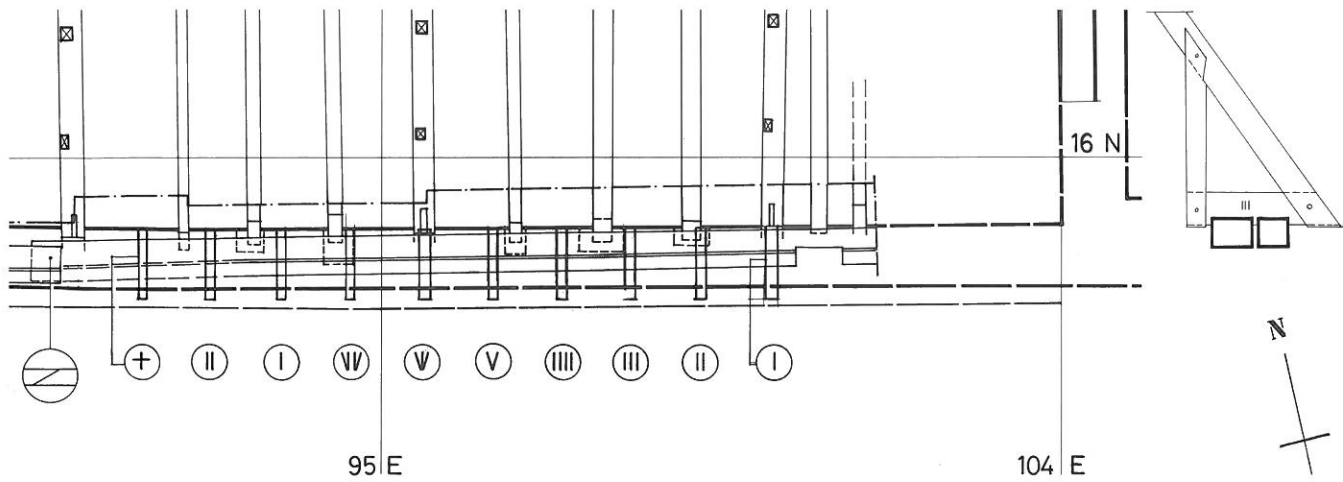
Mittelschiff-Dachstuhl, Osteil der Südseite. Grundriss und Ansicht mit Versetzmarken (Massstab 1:100/50).
